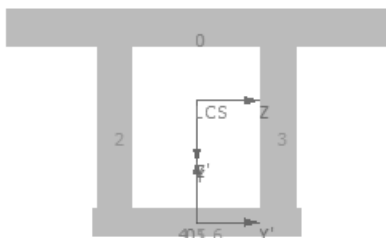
Поперечний переріз досліджуваної прогонової будови
